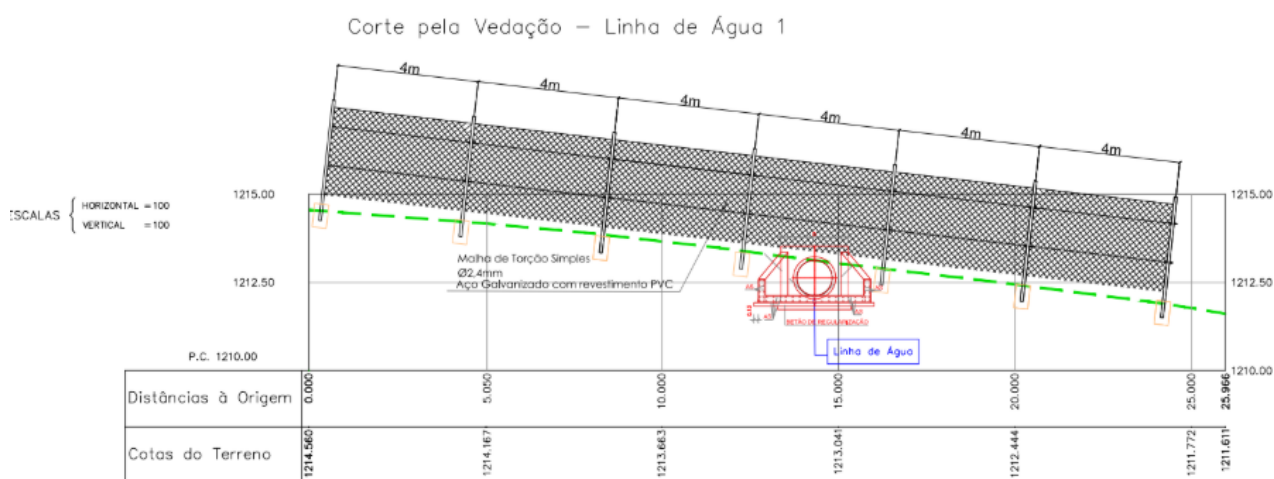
Perfil transversal à linha de água correspondente ao atravessamento situado mais a norte.
